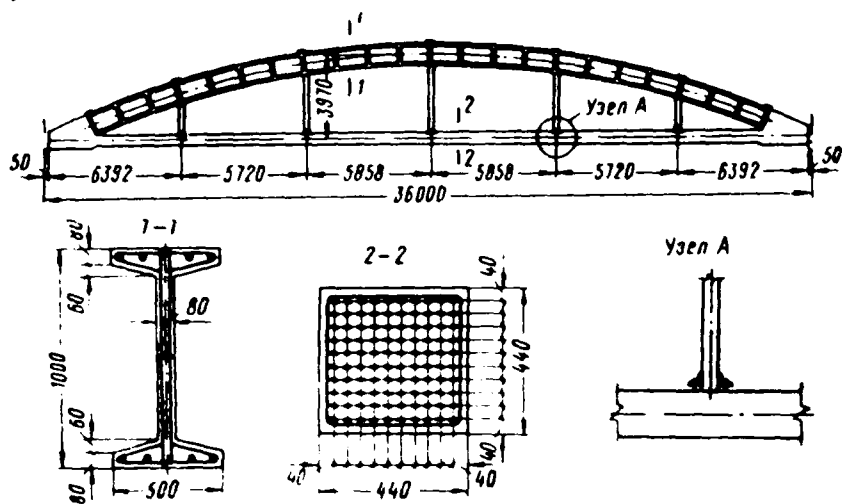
Арка из блоков (на примере пролета 36 м)
